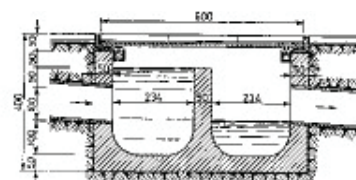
Pozzetto di scarico in cemento del tipo sifonato a doppia ispezione.
